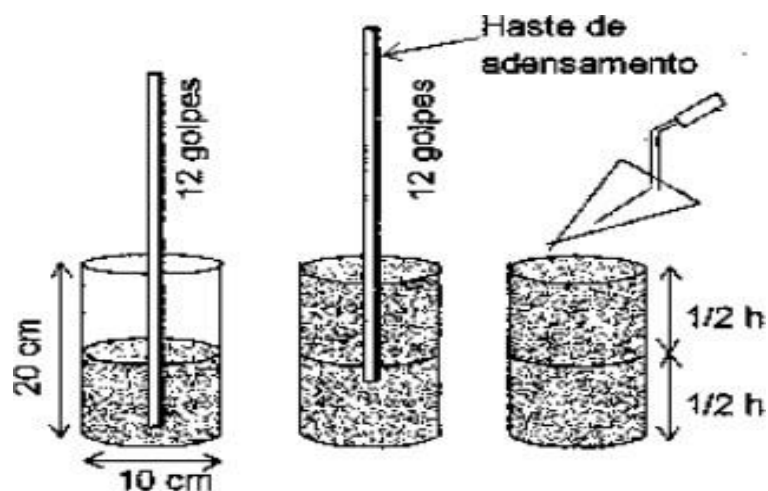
Sequência de moldagem dos corpos de prova. Fonte: <https://abre.ai/dzsK>
